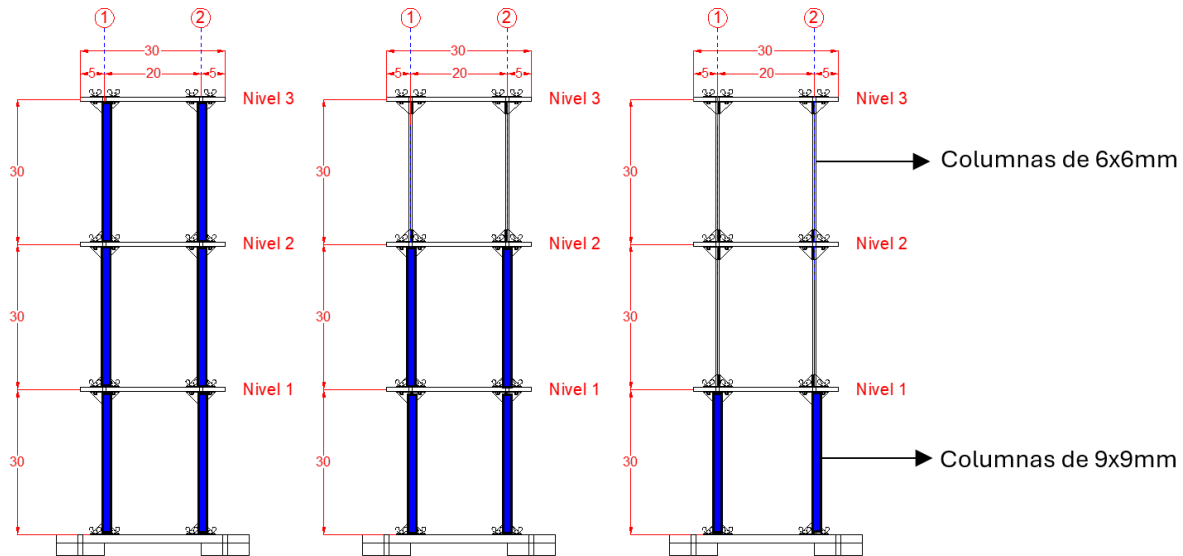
Posibles configuraciones del eje A para inducir la asimetría en rigidez
